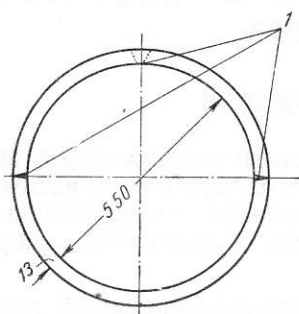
Трещины в стенке круглой железобетонной шахты
